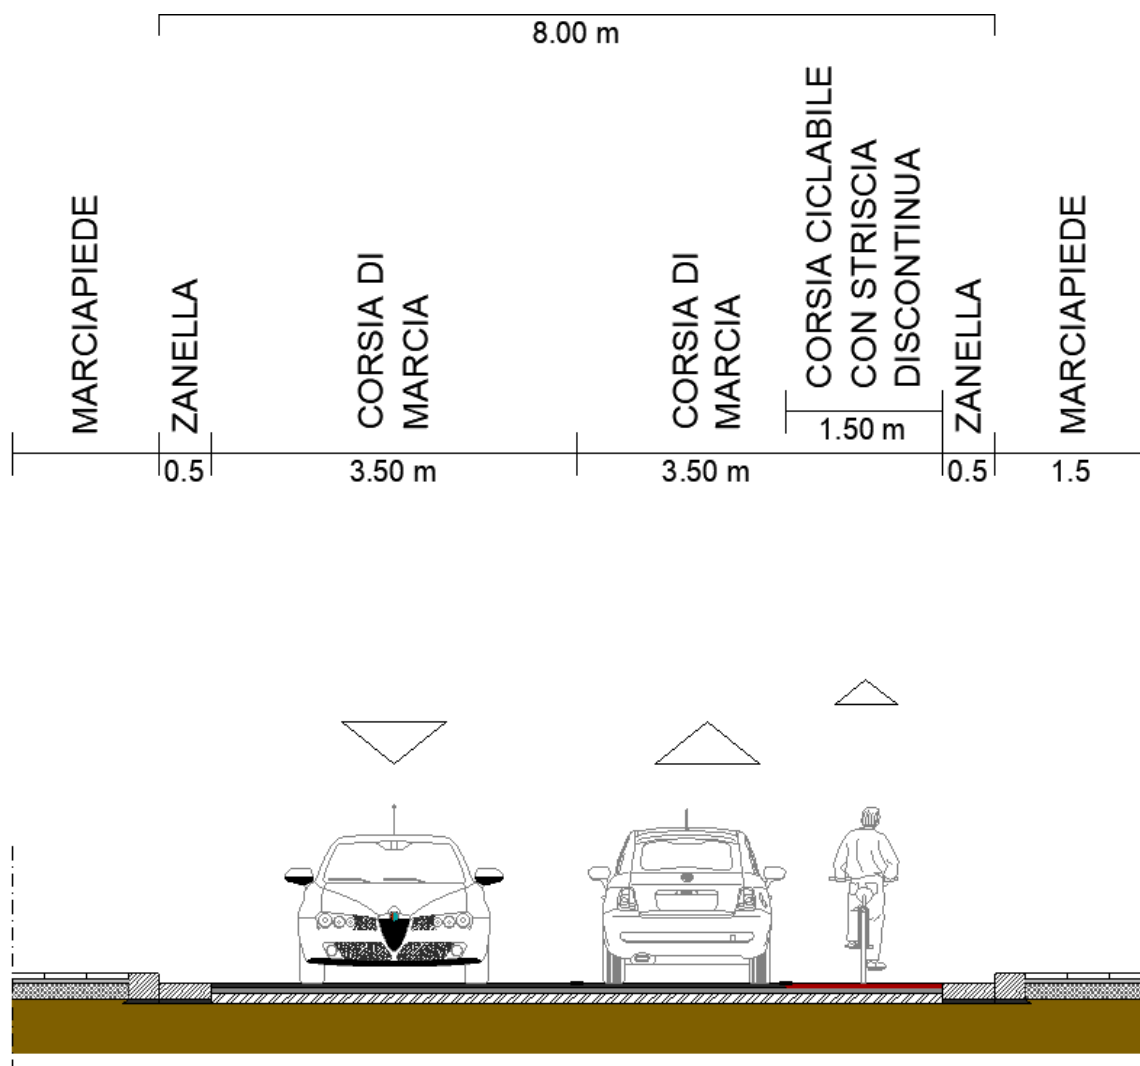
via Terracina, sezione trasversale di progetto (tratto di 200 m prima dell'intersezione con via Cassiodoro - via Consalvo – via Caravaggio).
